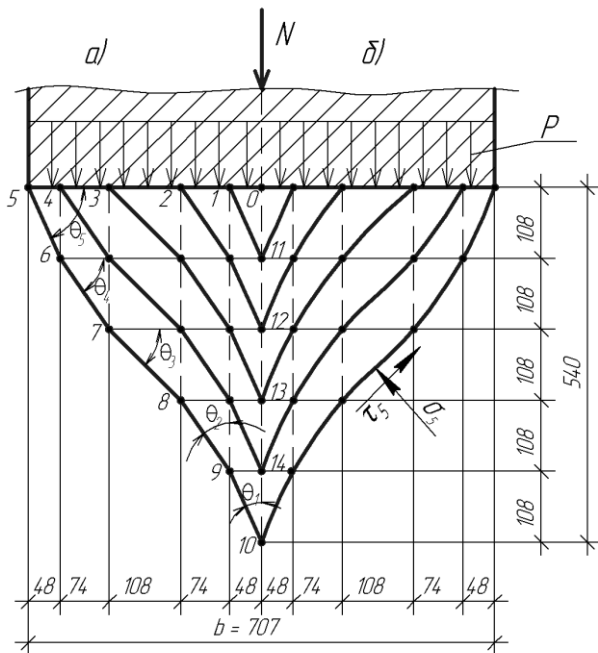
Расчетная форма уплотнённого ядра грунта в виде пирамидального тангенсоида под квадратной подошвой фундамента в супесчанистом основании
